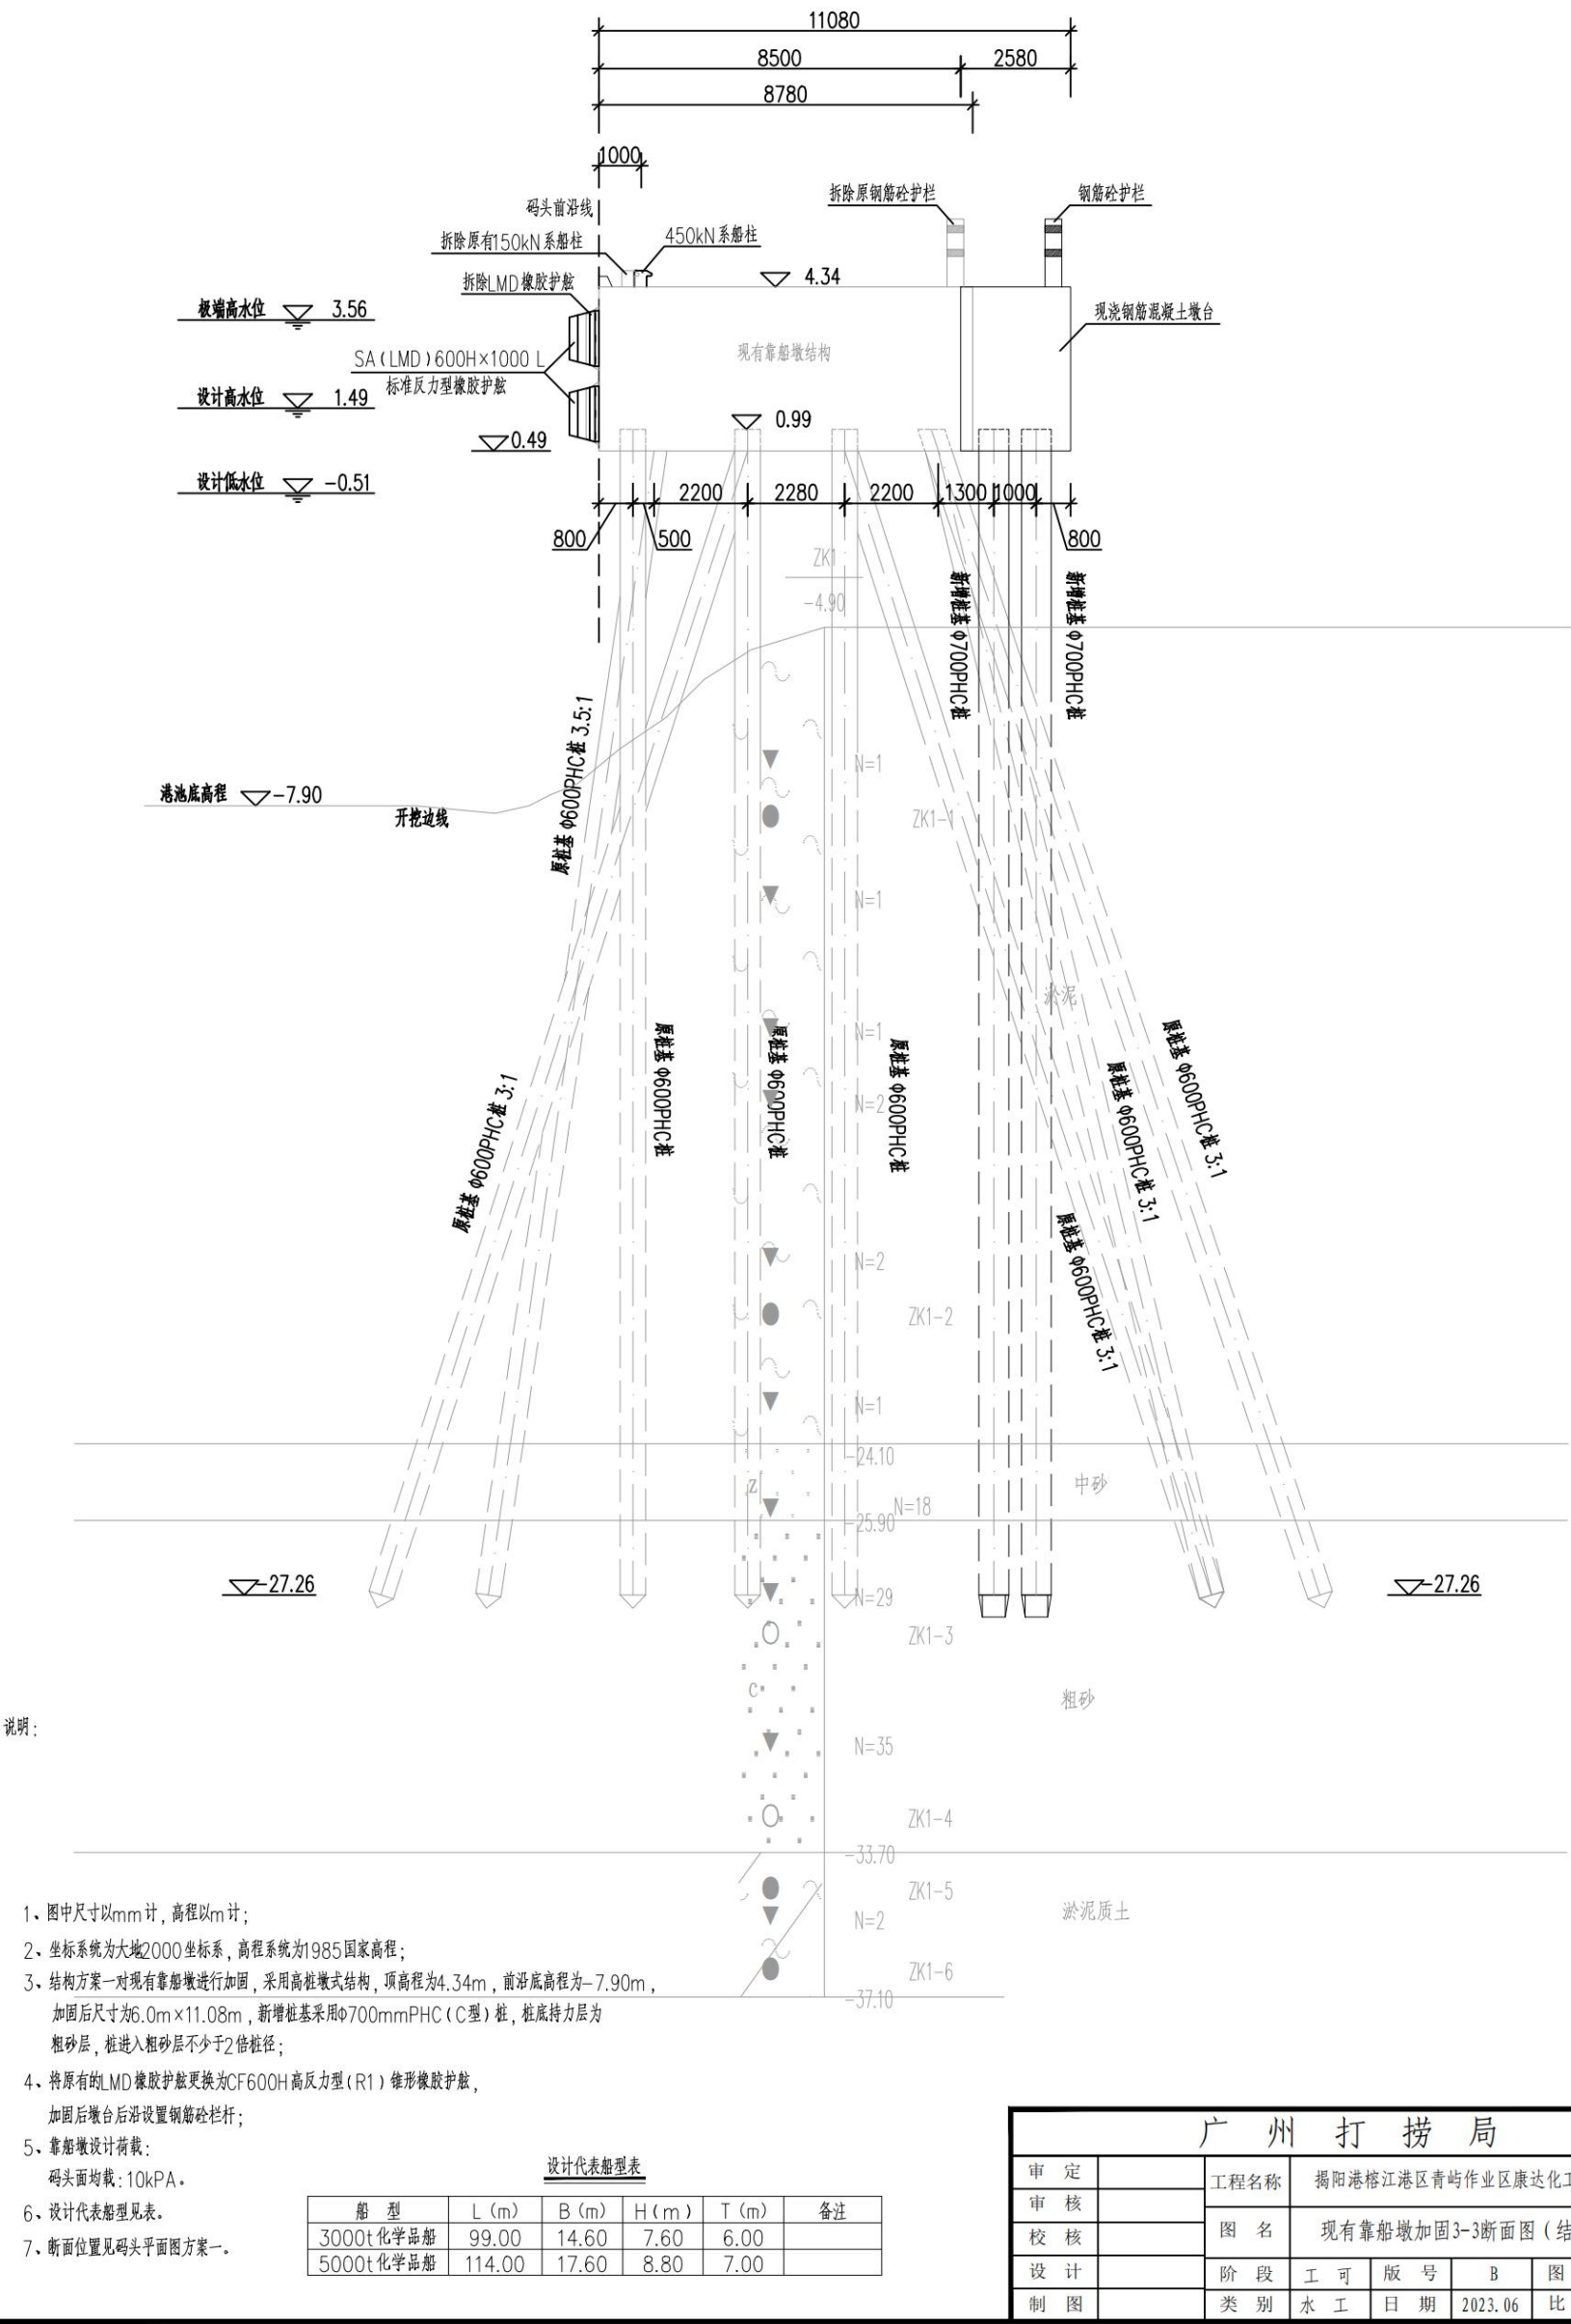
现有 1#、2#系船墩加固 3-3 断面图
